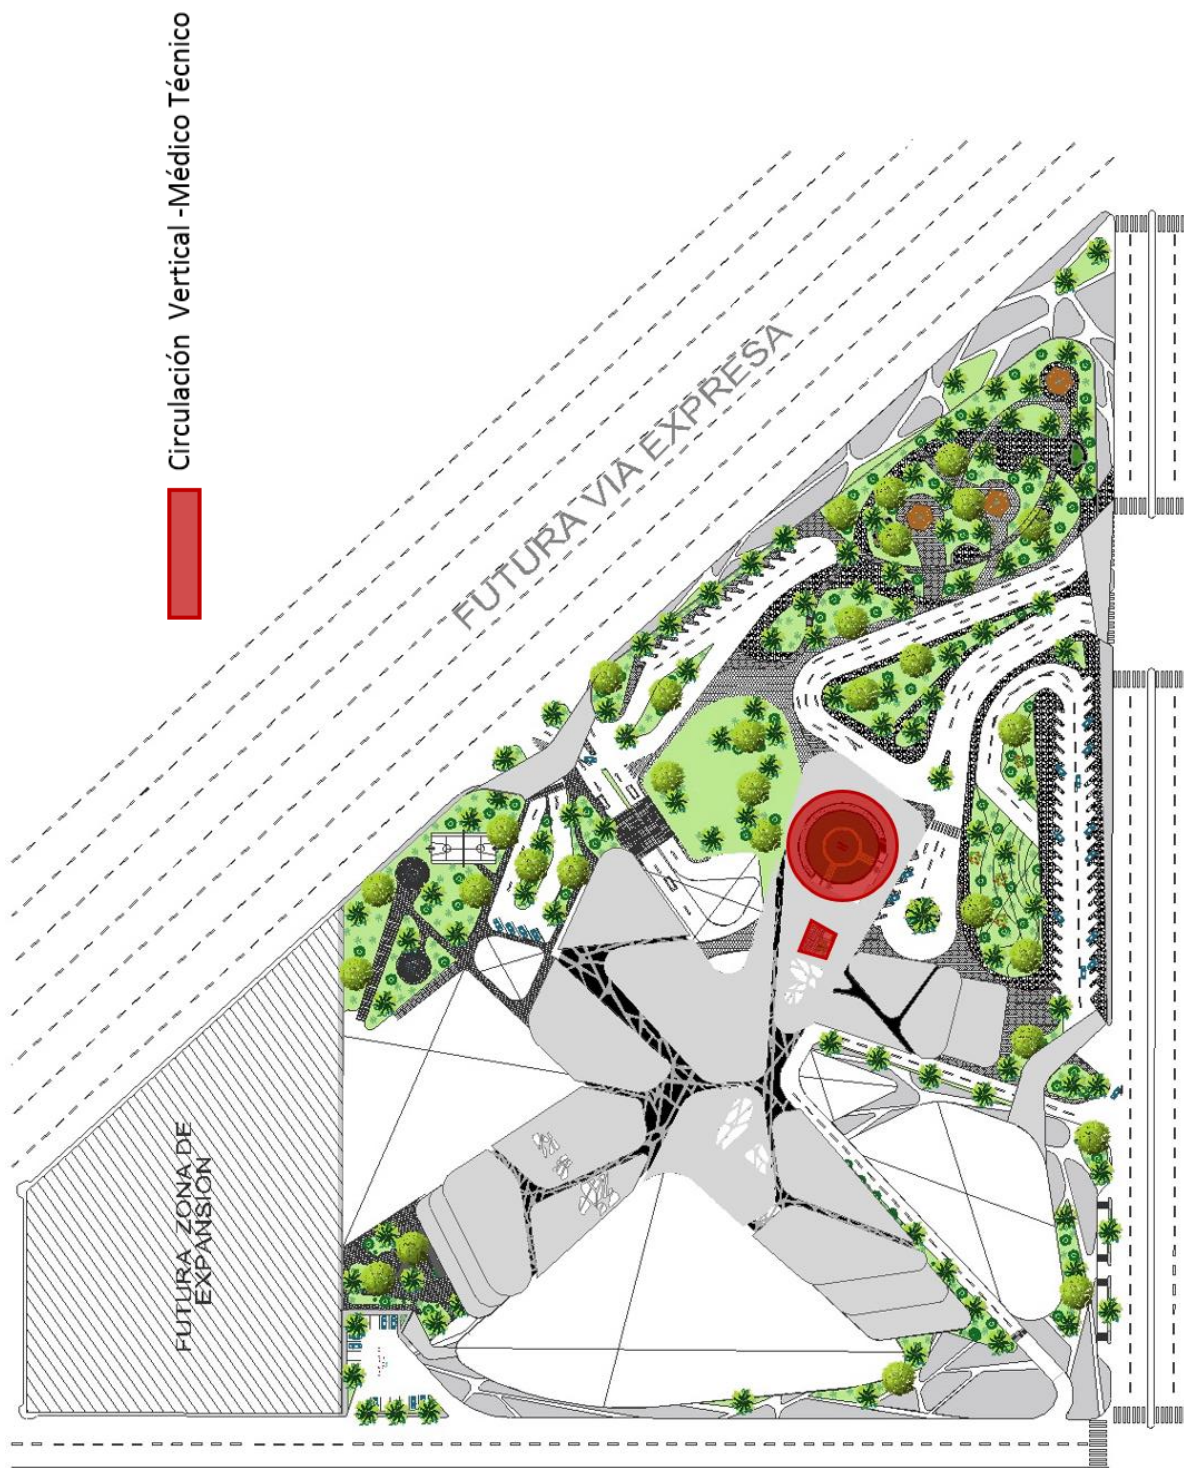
Circulación de Plano de Techos de la Propuesta Arquitectónica.
